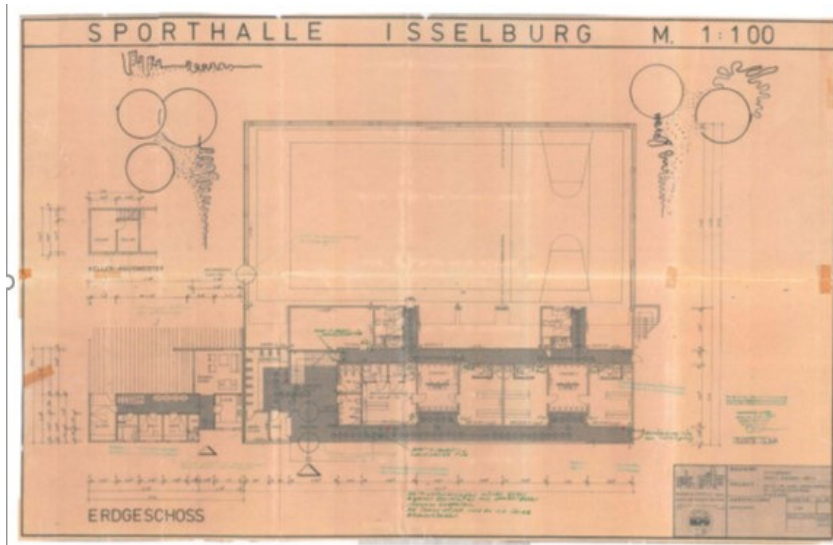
Grundriss Turn- und Mehrzweckhalle Anholt
